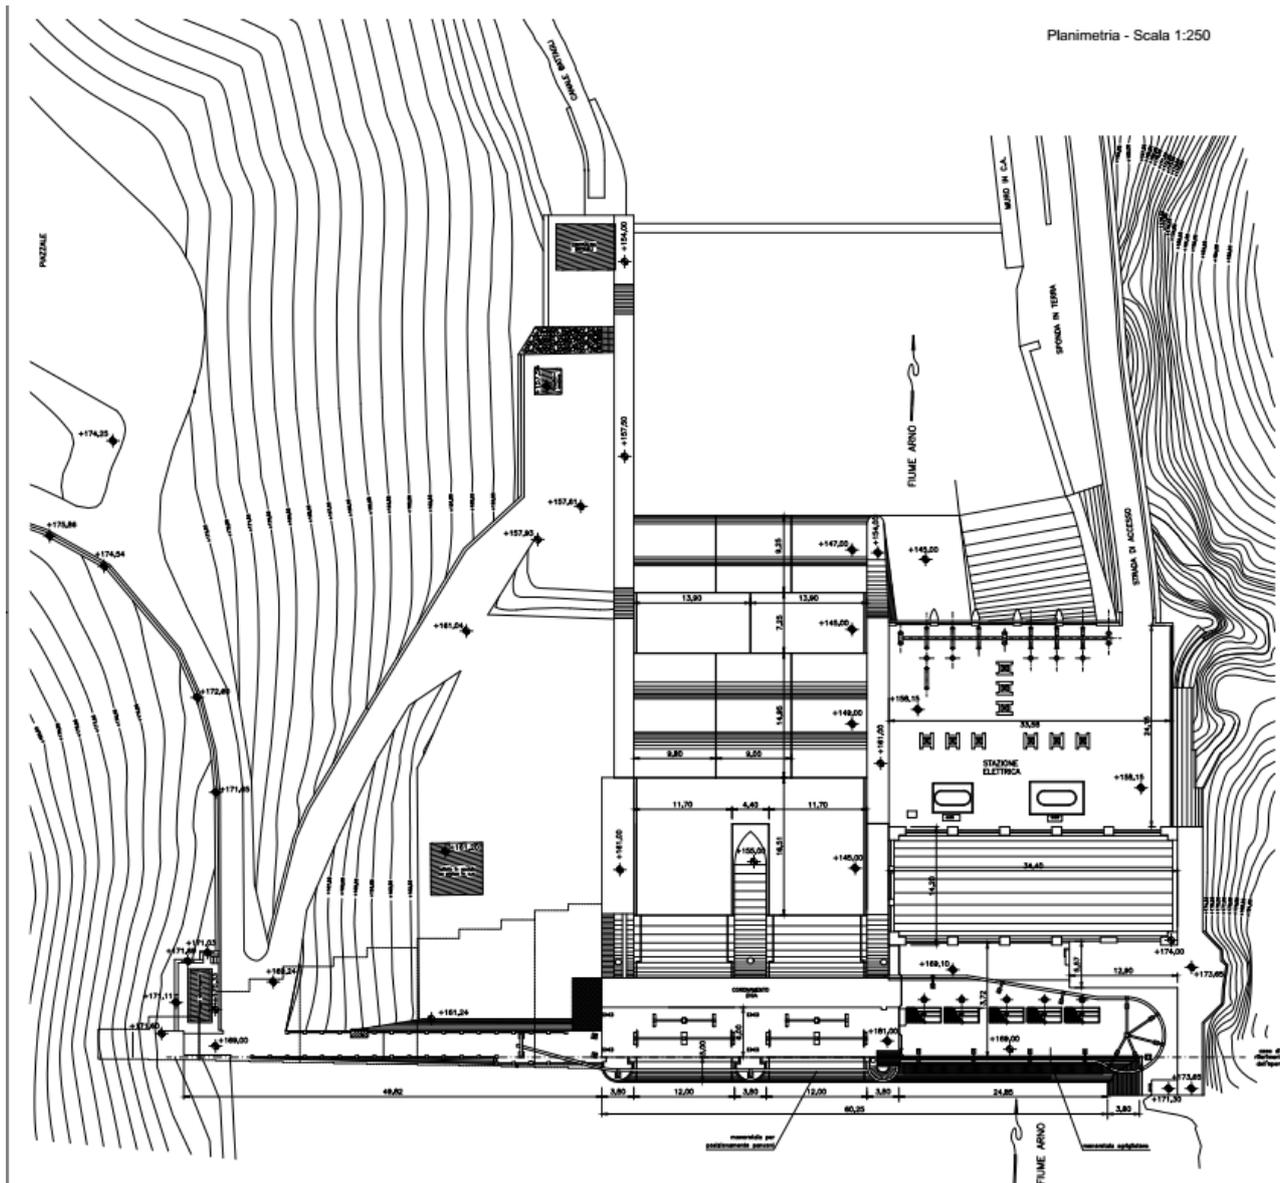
2 – Estratto planimetrico area Diga – Stato di consistenza
